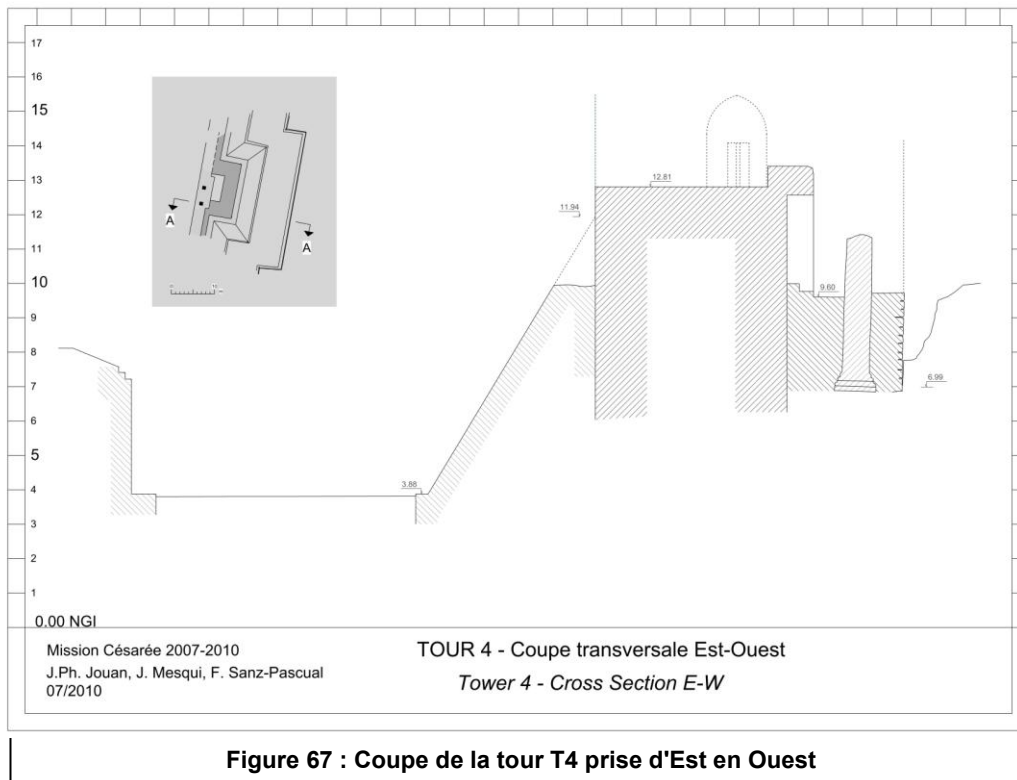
Coupe de la tour T4 prise d'Est en Ouest
